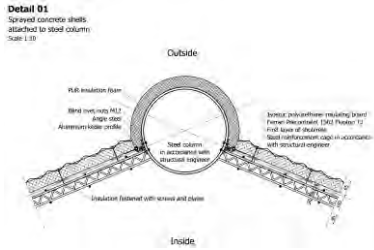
Immagine di riferimento per il dimensionamento dei piedritti
